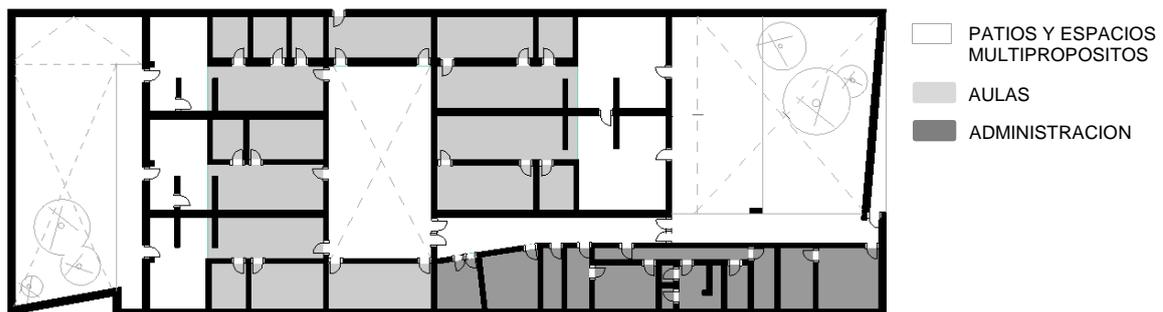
Vistas de Planta Primer Nivel de la Escuela infantil en Berriozar
